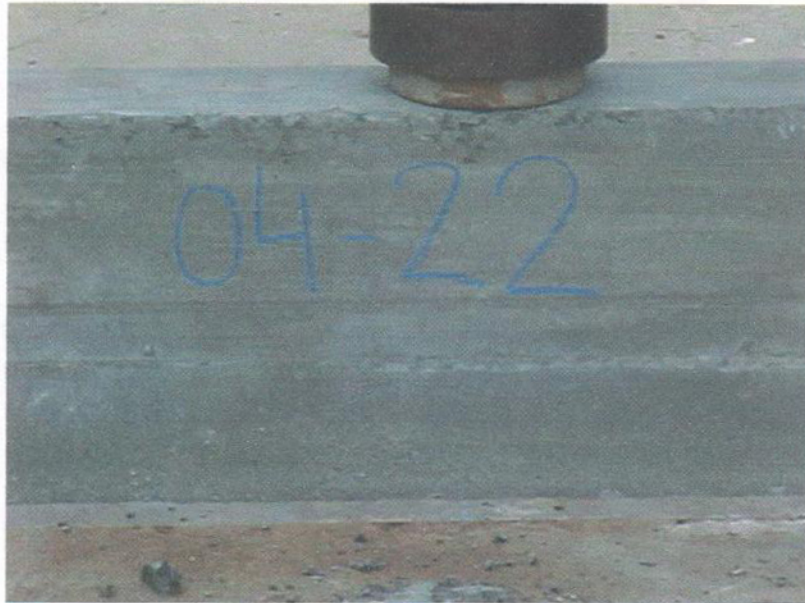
Posicionamento da viga no início do ensaio (Amostra 04 – concreto Fck 22Mpa).
